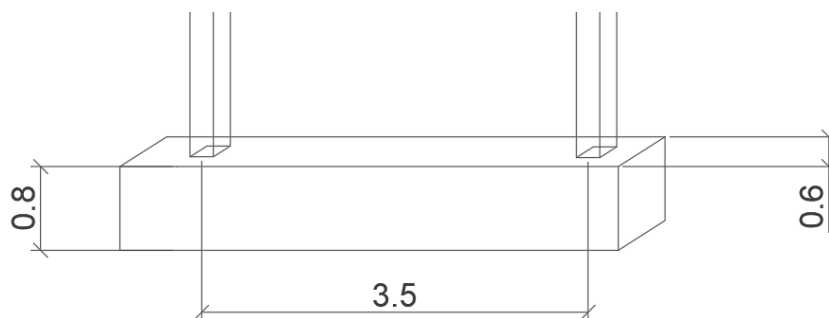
Dimensiones de la zapata y separación máxima entre pilares
